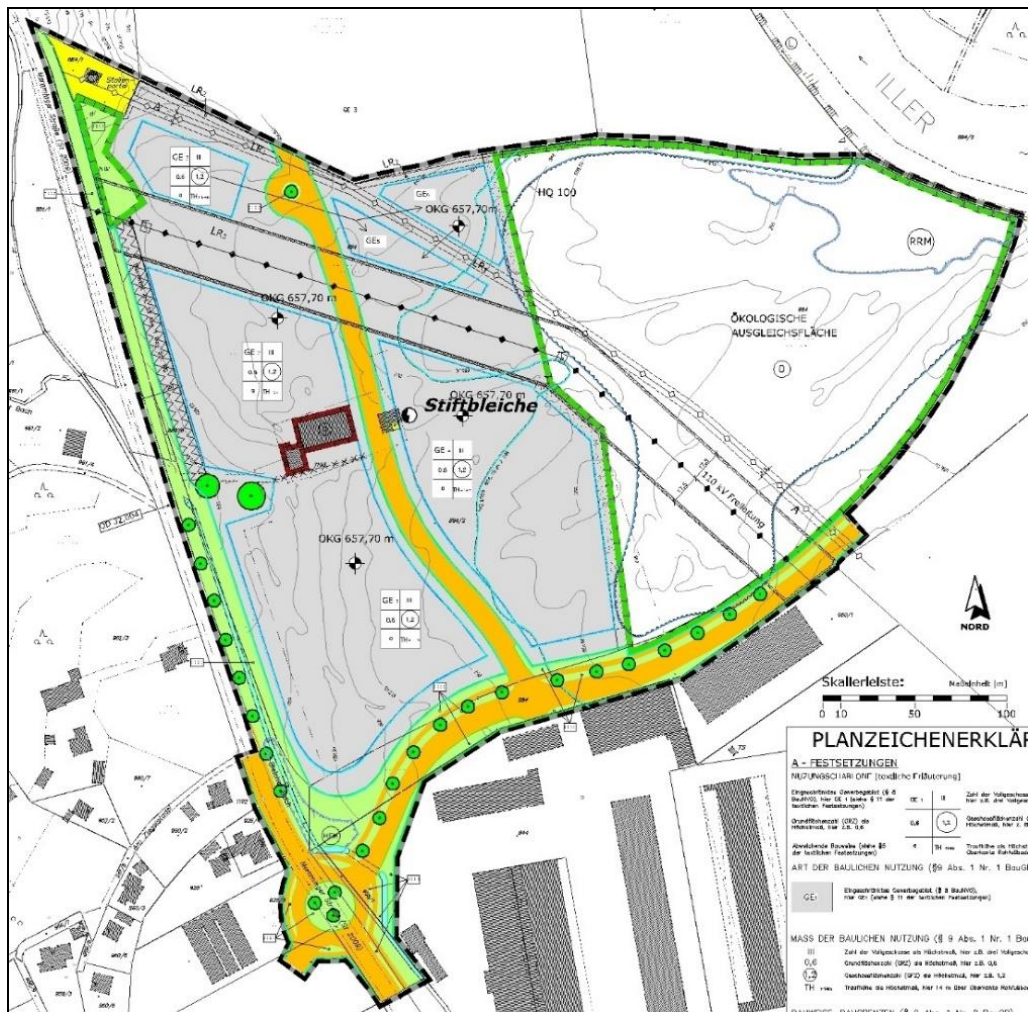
Auszug aus dem Bebauungsplan „Stiftsbleiche“ [14]
